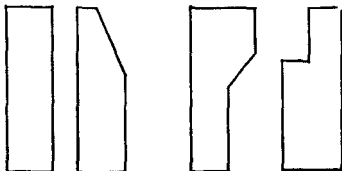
COLUMNAS DE MADERA LAMINADA.
